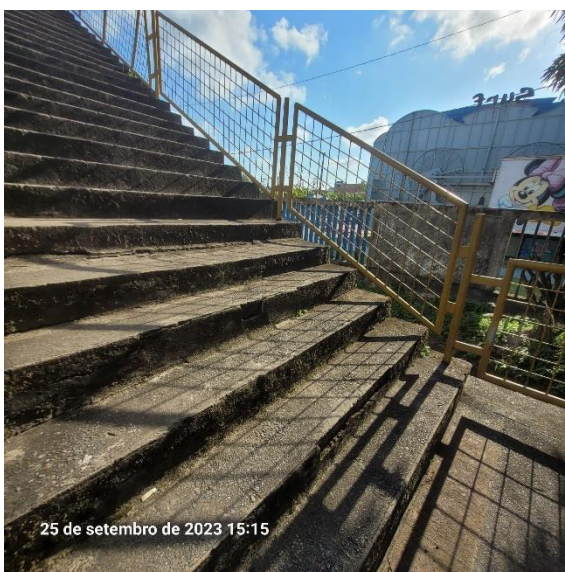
Estrutura em concreto armado das escadas e passarela necessitando recuperação geral. Degraus fora de padrão
